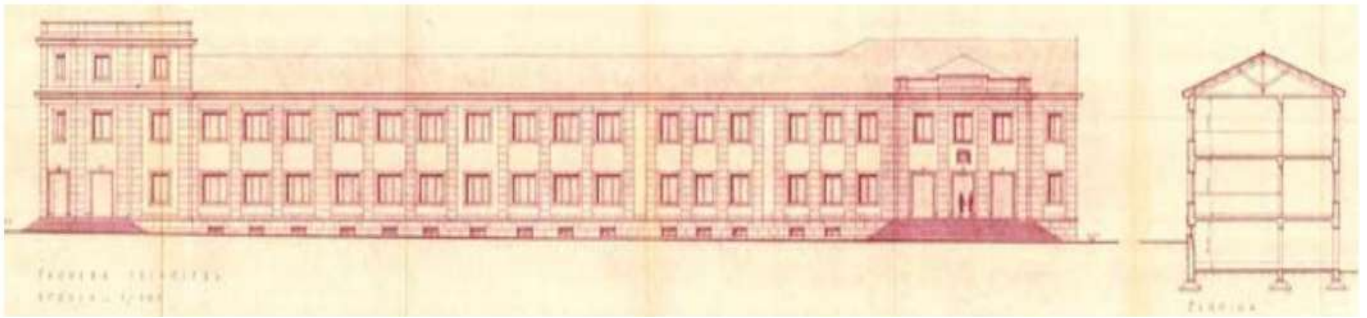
Instituto femenino. Alzado y sección. Navarro Borrás, 1952
